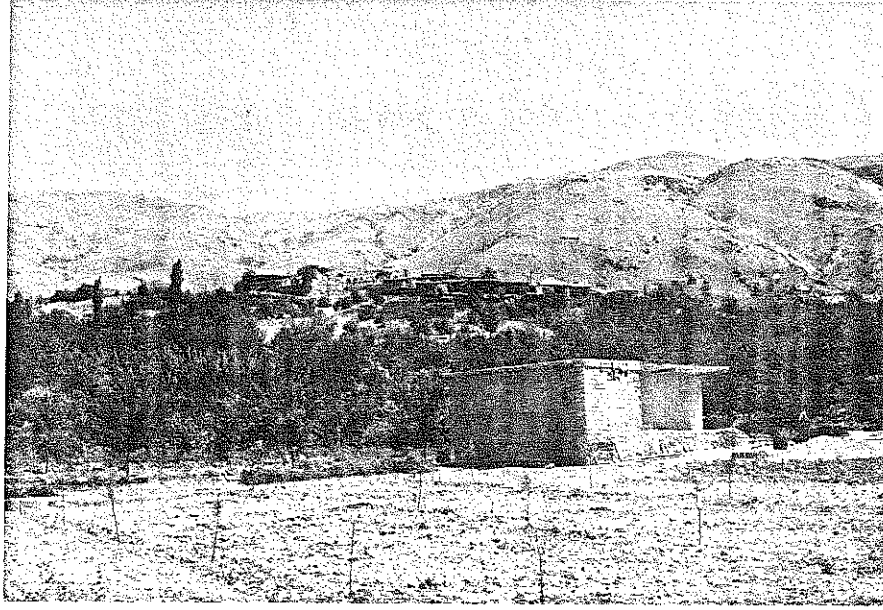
Düztarla Mahallesiindeki Yeni Betonarme Konutlar
